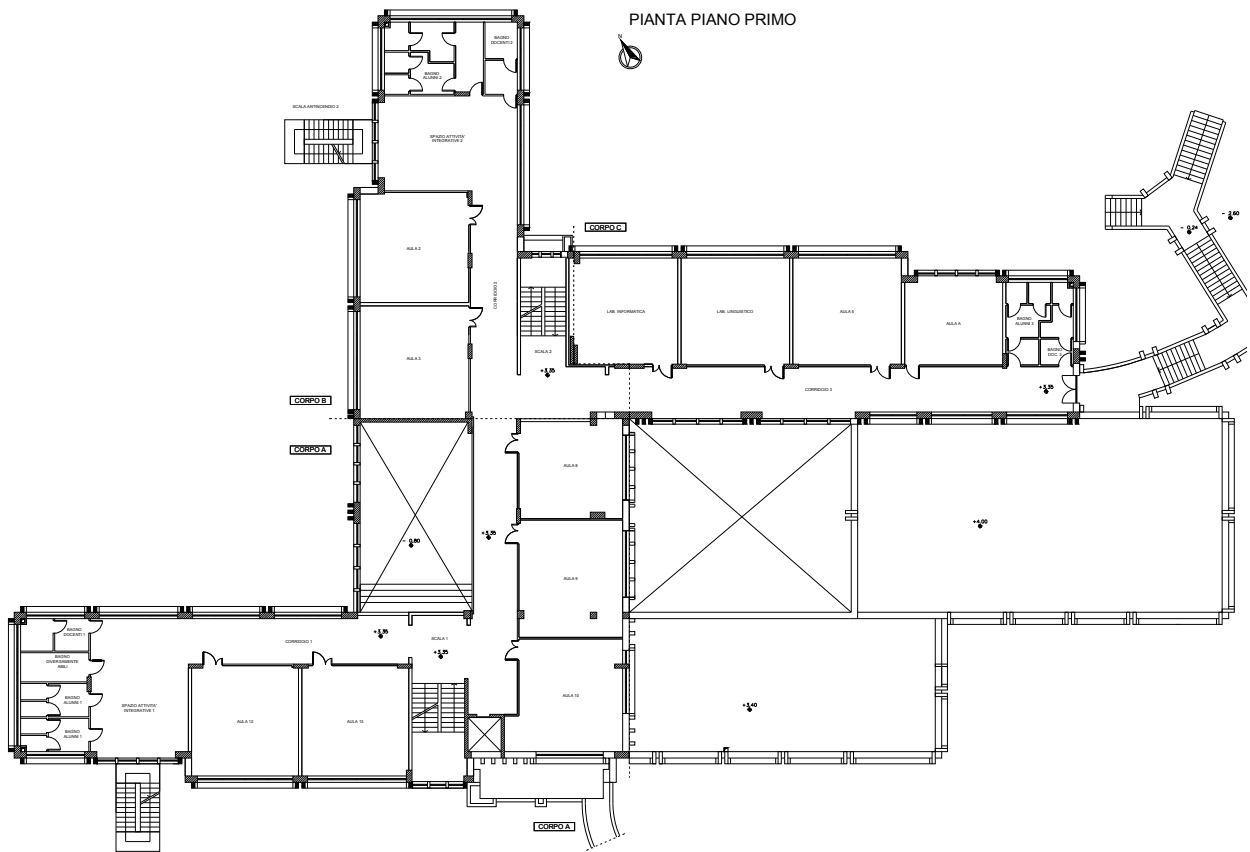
Pianta Piano Primo – Stato Futuro
